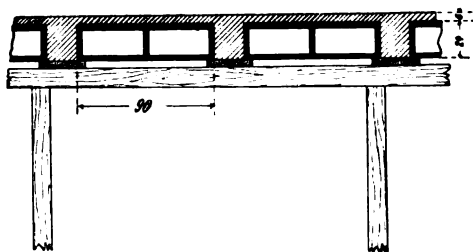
Verschalung einer Decke mit Hohlkörpern nach Züblin.
